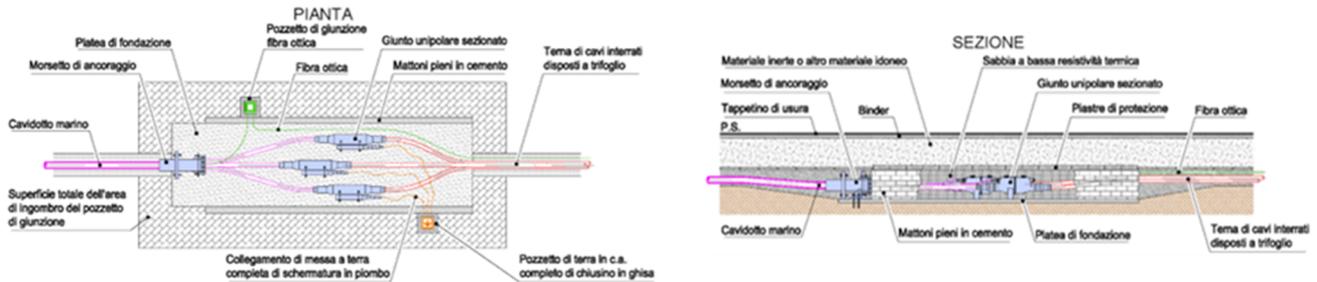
Pianta e sezione tipo del pozzetto di giunzione mare/terra.
